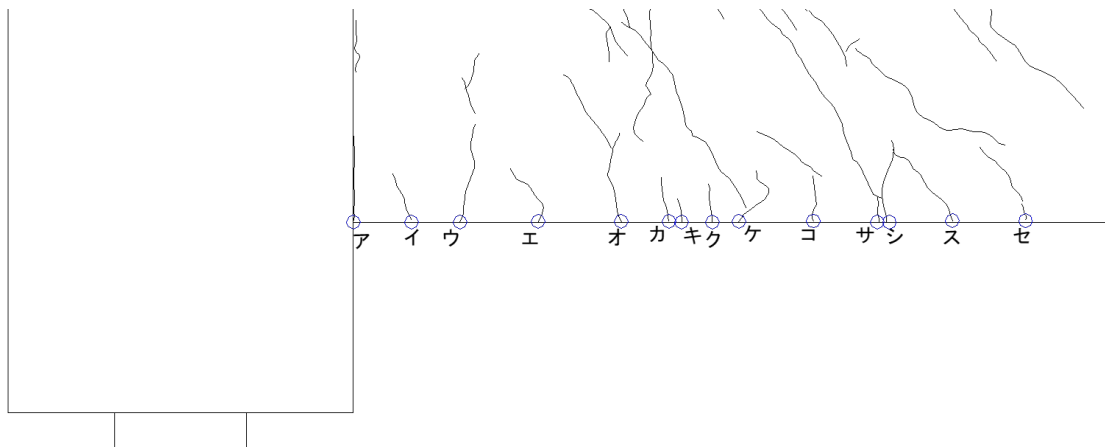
基礎梁ひび割れ幅測定位置(試験体 B-1 正載荷)
